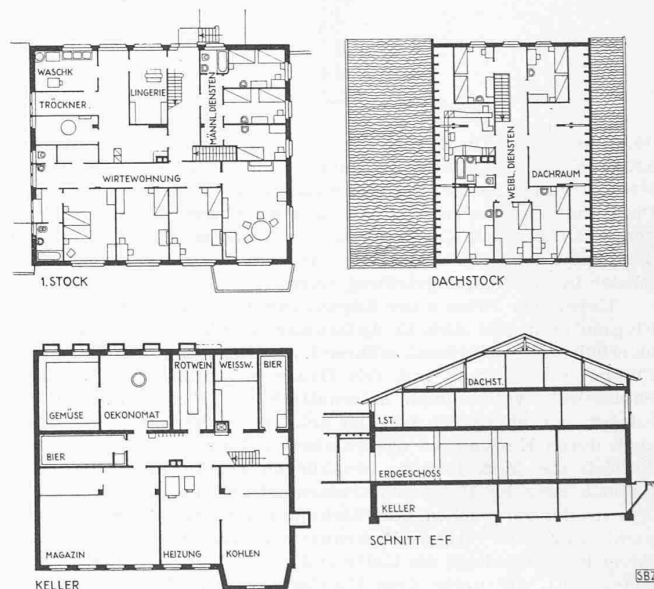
Grundrisse und Schnitt vom Hauptbau. — 1 : 500
